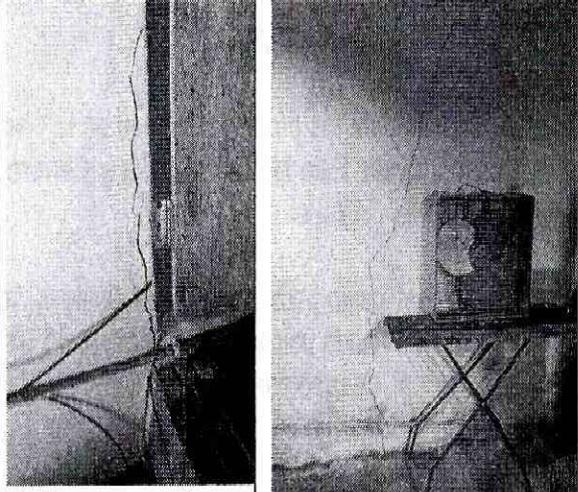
y 14 Fisura muros divisorios la Carrera 15 Bis E No 57- 24 Sur por fallas constructivas.
